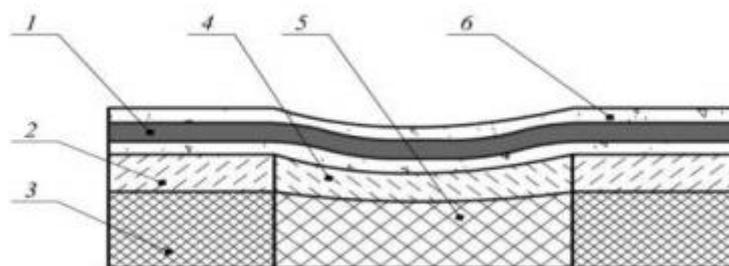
Схема осадки наземного нефтепровода: 1 – нефтепровод; 2 – оттаявший непросадочный грунт; 3 – мерзлый непросадочный грунт; 4 – оттаявший просадочный грунт; 5 – мерзлый просадочный грунт; 6 – песчаная насыпь
